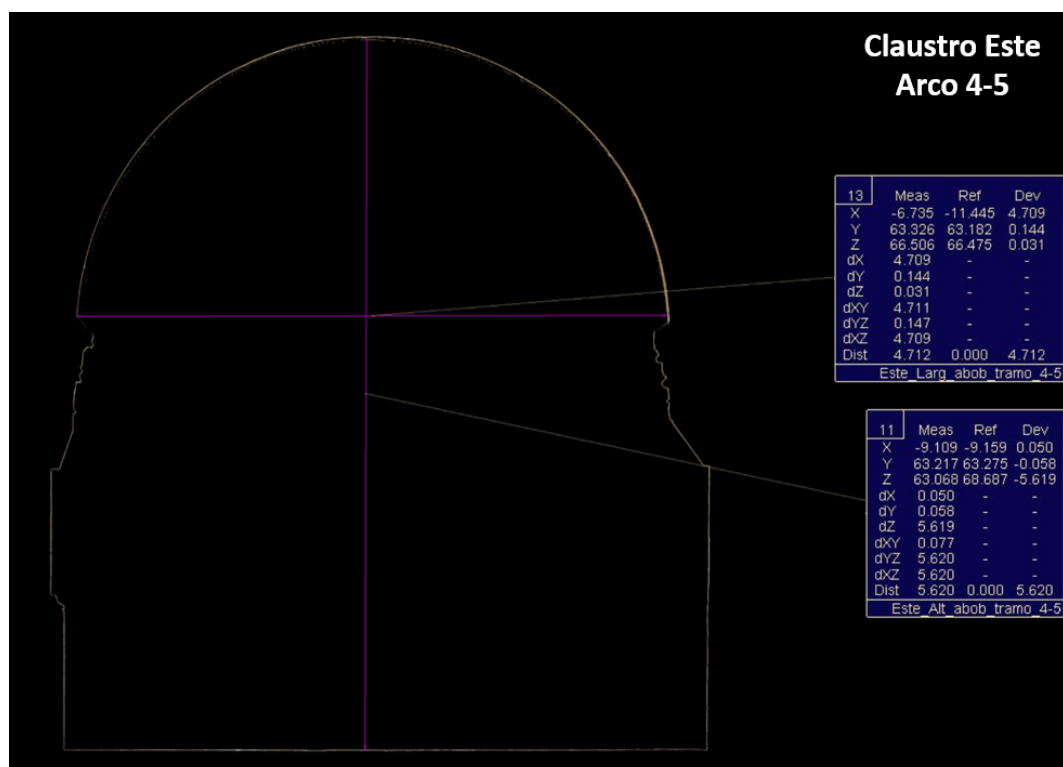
Corte transversal do Arco 4-5 do claustro Este de D. Dinis.
